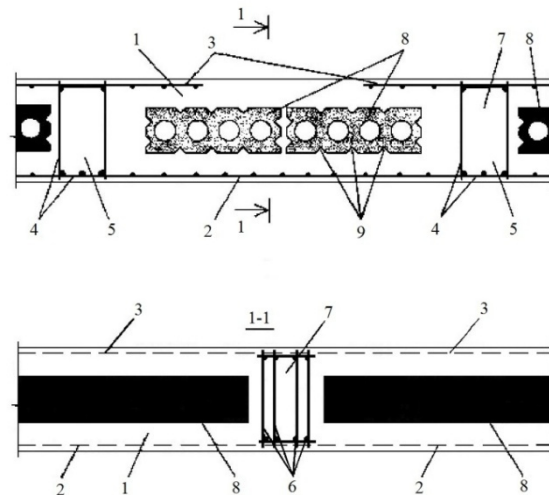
Конструкция сборно-монолитного железобетонного перекрытия: 1 – балочная плита; 2, 3 – арматура нижней и верхней сеток; 4 – арматурный каркас второстепенной балки; 5 – второстепенная балка; 6 – арматурный каркас главной балки; 7 – главная балка; 8 – вкладыш с пустотами; 9 – углубления во вкладыше
